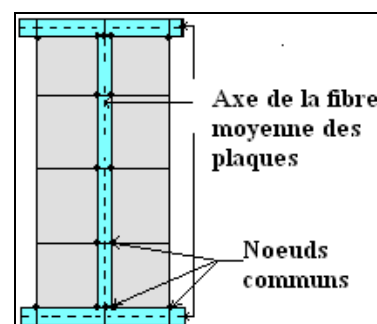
Connexion de la poutre avec les deux panneaux en béton
